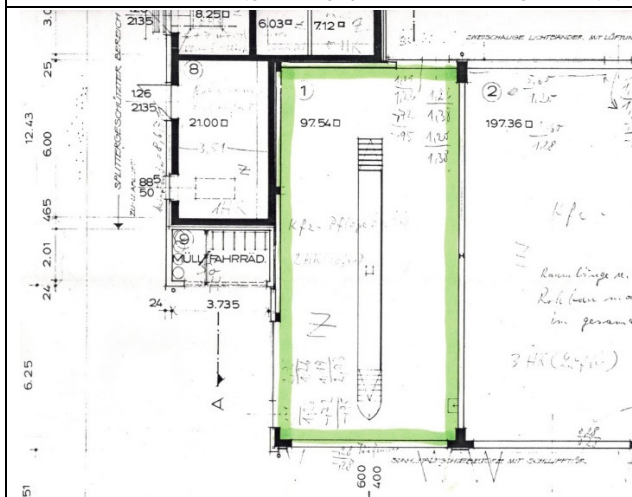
Grundriss (grün = geplanter Schulungsraum) (© Brinkmann)
